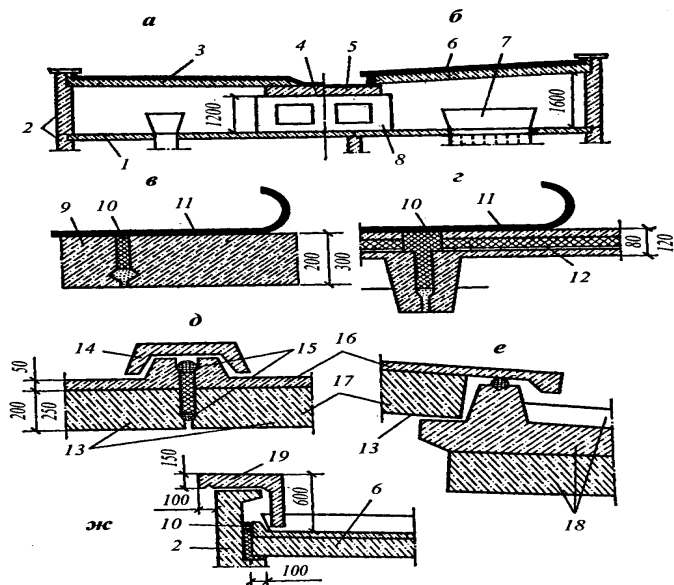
Железобетонные крыши с теплым чердаком:
